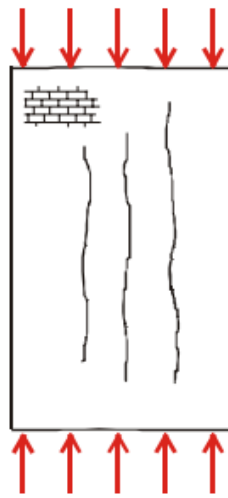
fissuras verticais causadas por sobrecarga (DUARTE, 1998).
